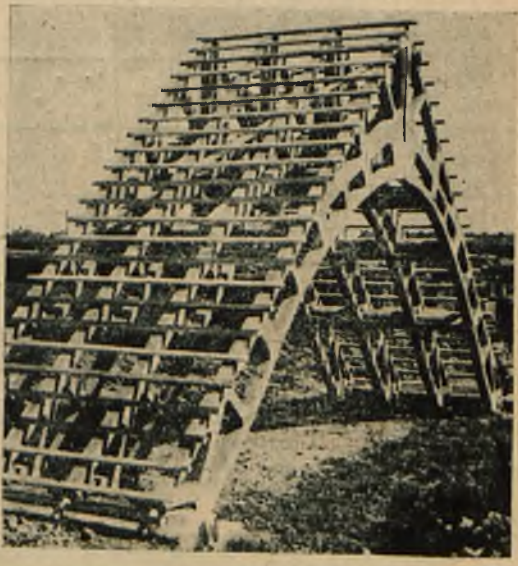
Fragment konstrukcji dachowej z drzewobetonu system jak na fig. 1 — widoczne sąłaty pod pokrycie dachówki. Rozpiętość 9,00 m.
